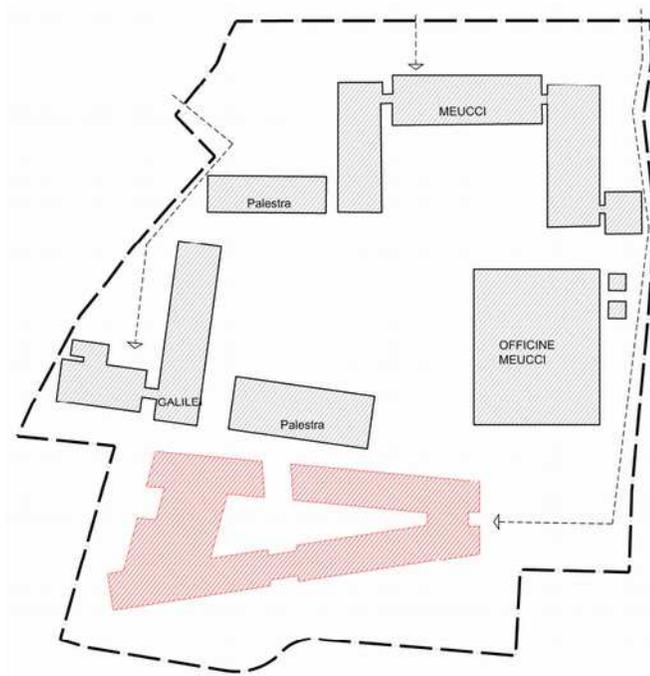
Schema FASE 2 costruzione edificio 1
